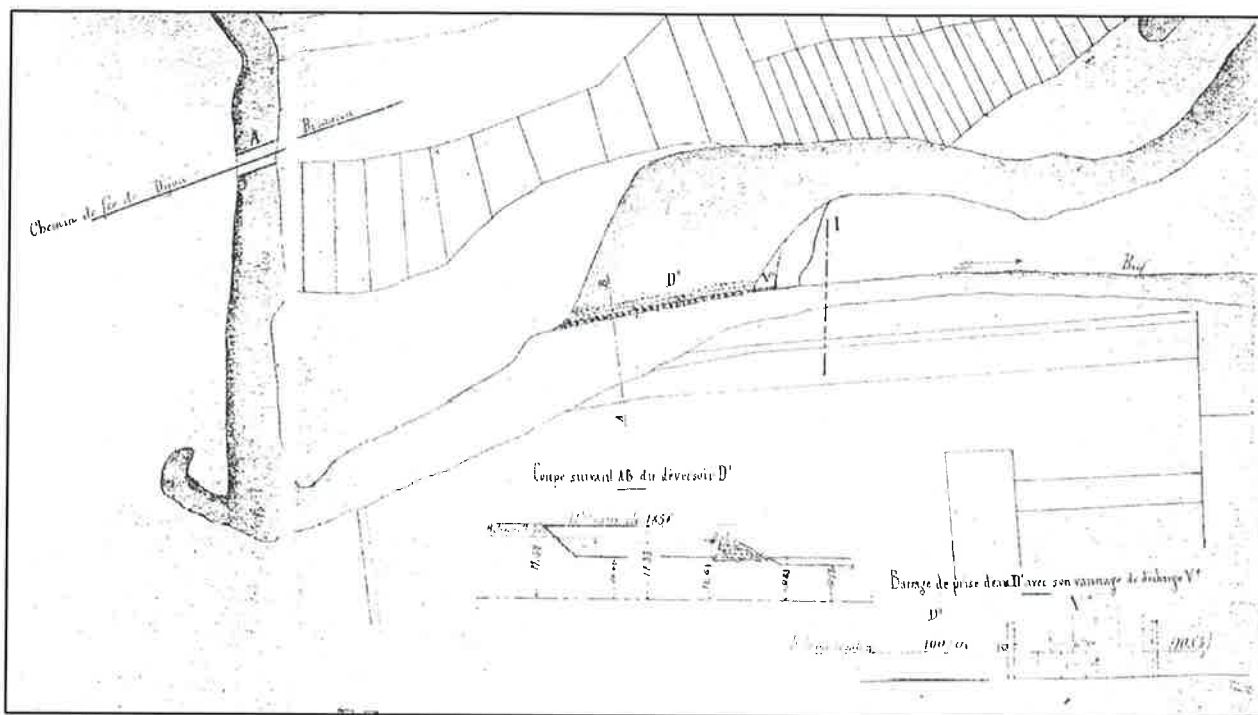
Extrait des plans des ouvrages en date du 27 février 1858 (source : Archives de la DDT21)
